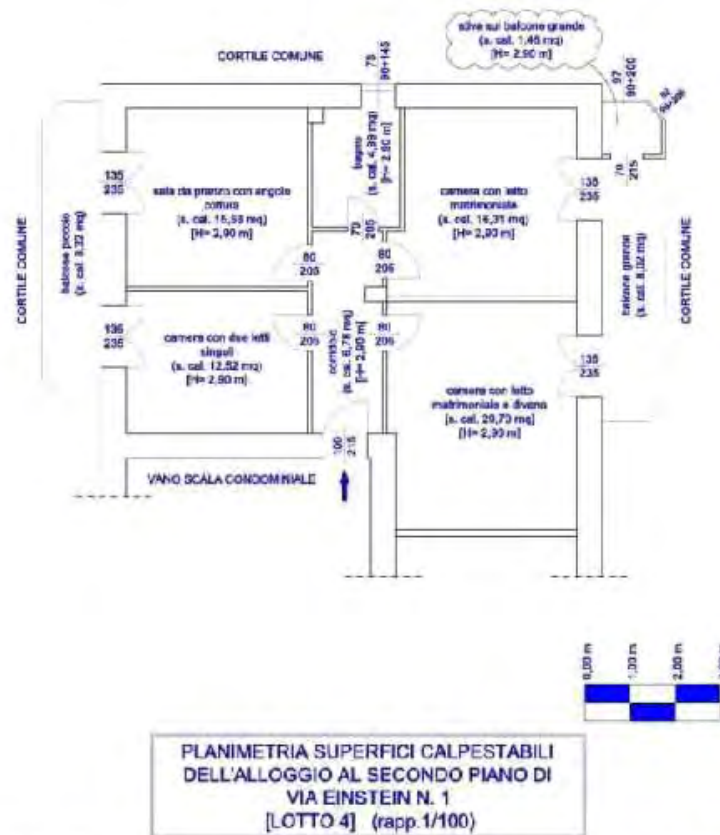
Planimetria urbanistica alloggio al secondo piano (26.6.2018)
